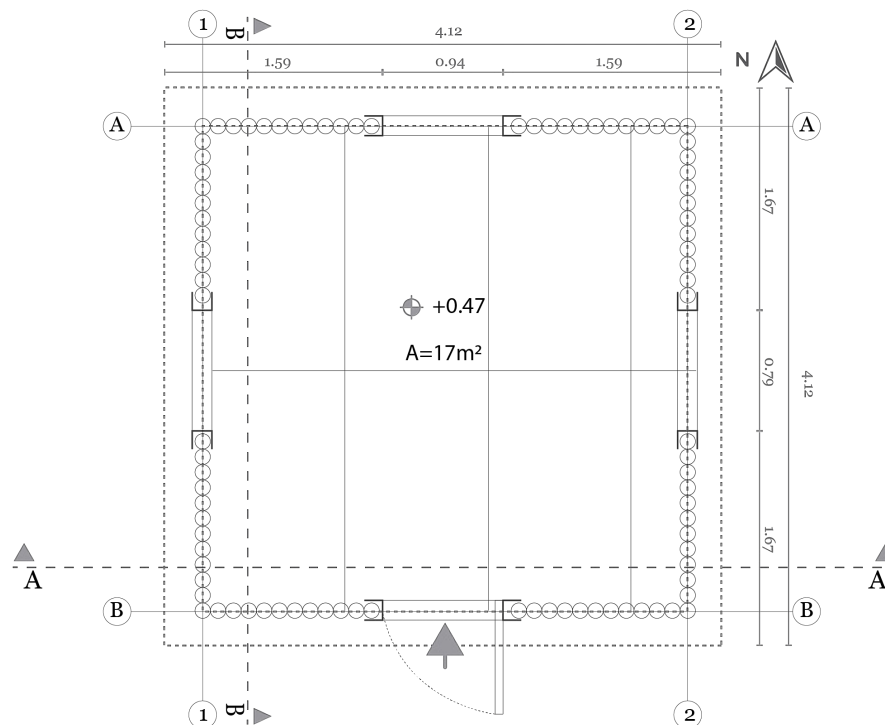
Planta Arquitectónica Paper Log House. Elaboración: Autores. Escala 1:50.
